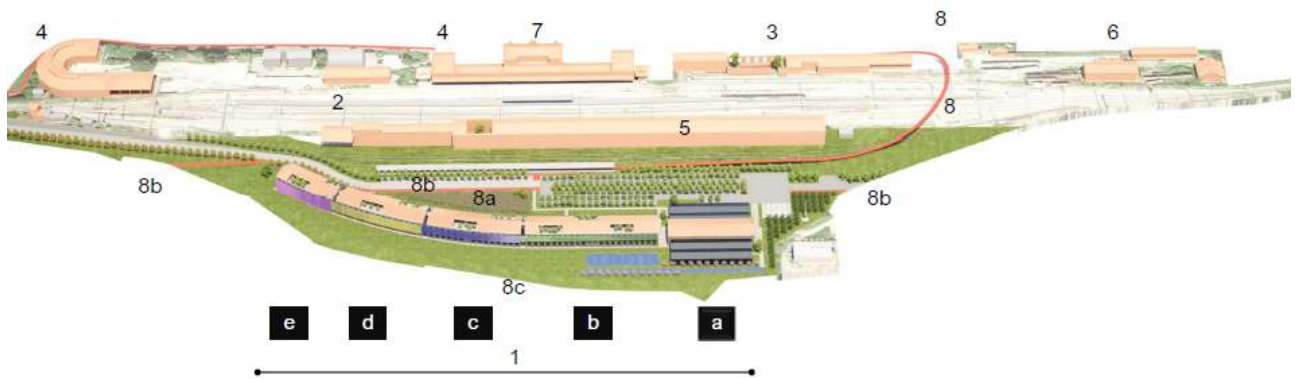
Estratto Masterplan - planimetria generale proposta di intervento progetto a cura dell'Arch Tagliabue Corrado.
